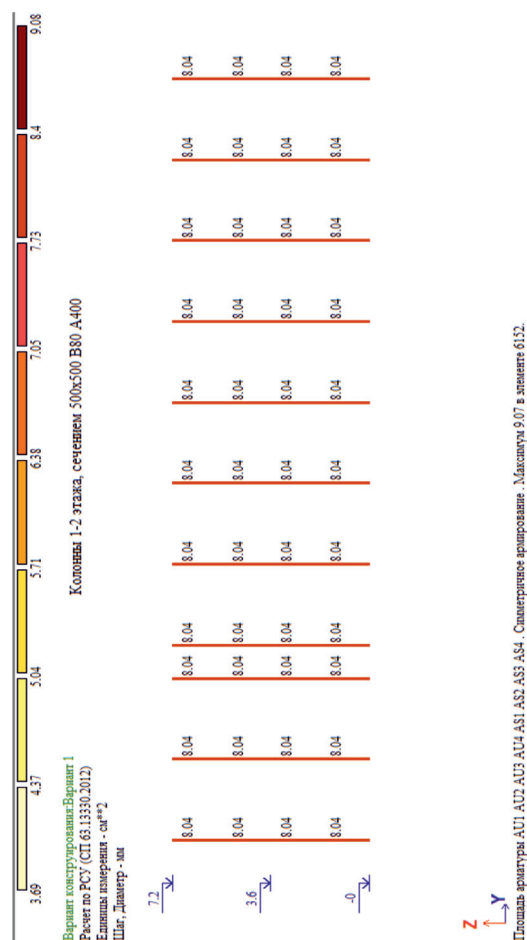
Армирование колонн 1 и 2 этажей по осям 6, 7. Сечение 500х500, бетон В80
